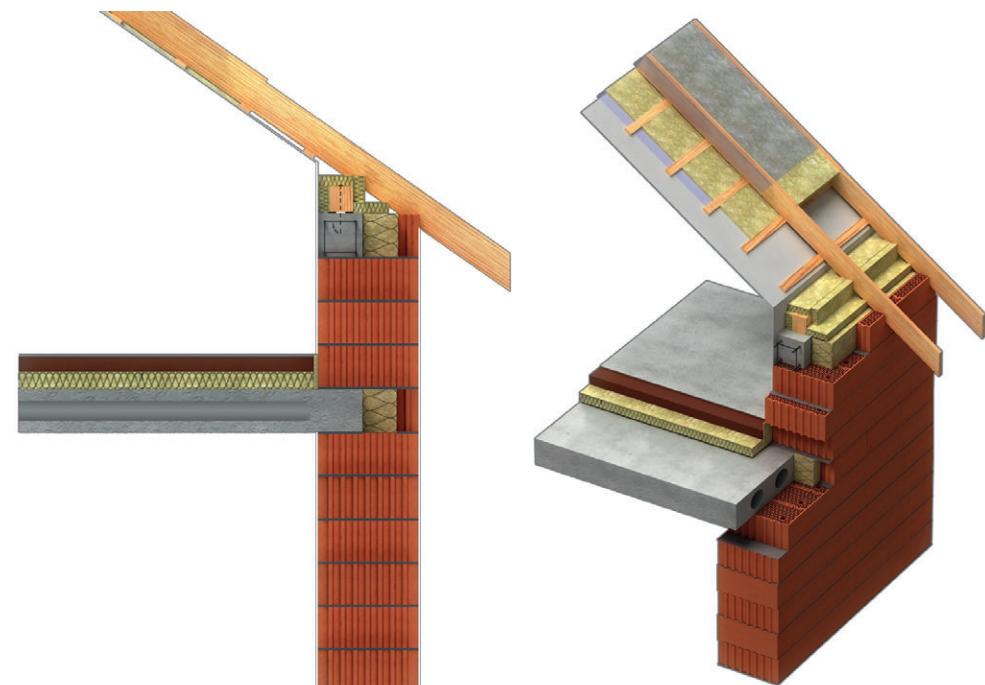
Устройство скатной кровли. Крепление маузерлата к монолитному бетонному поясу
